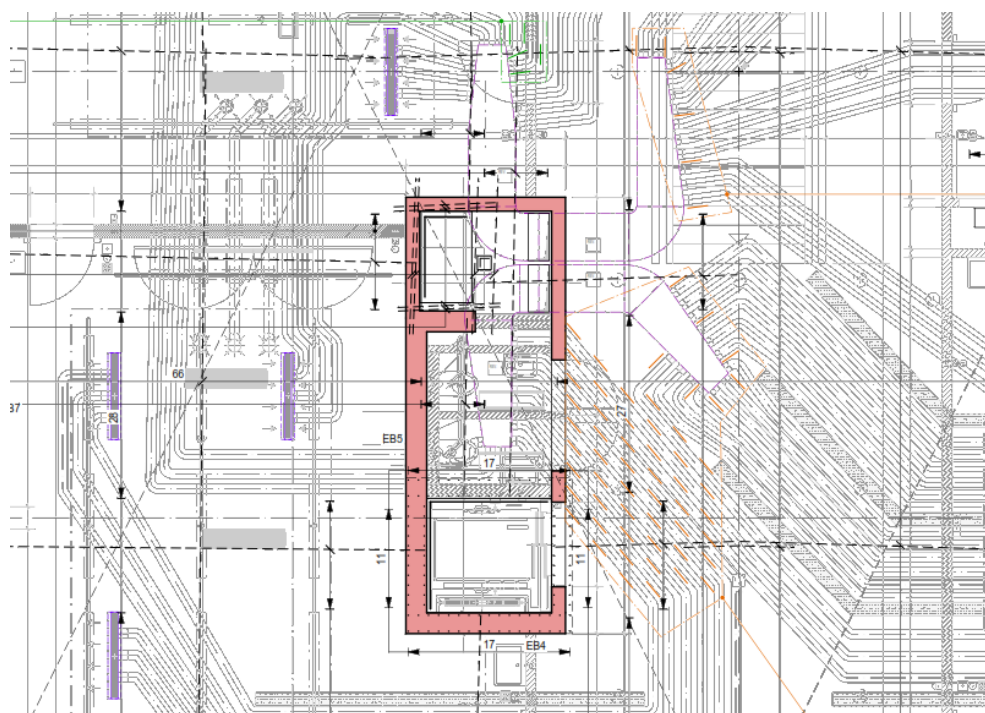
Pianta strutturale tipo e sezione lungo la scala interna.
